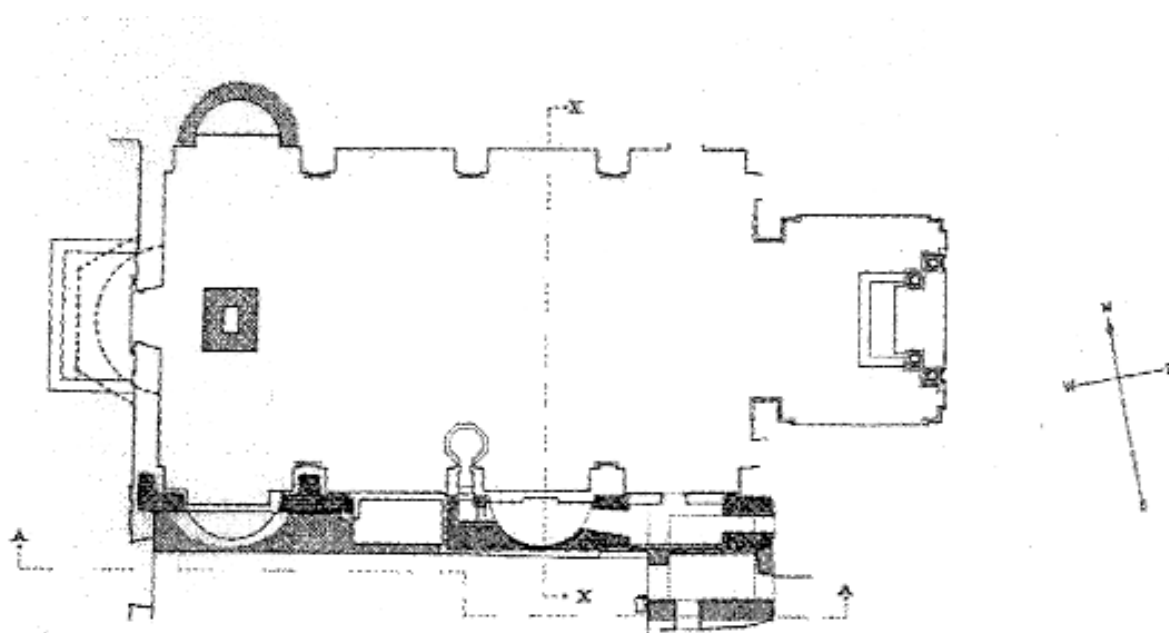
SS. Quirico e Giulitta. Pianta ricostruttiva delle fasi dell'edificio. Rilievo e disegno S. Corbett (da CBR IV, tav. 3).
